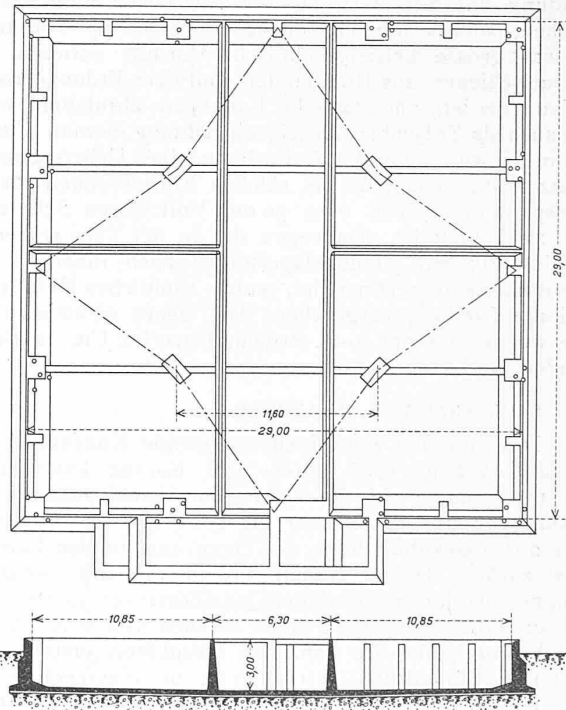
Fundament eines Kühlturmes. Grundriss und Schnitt, 1 : 400.
